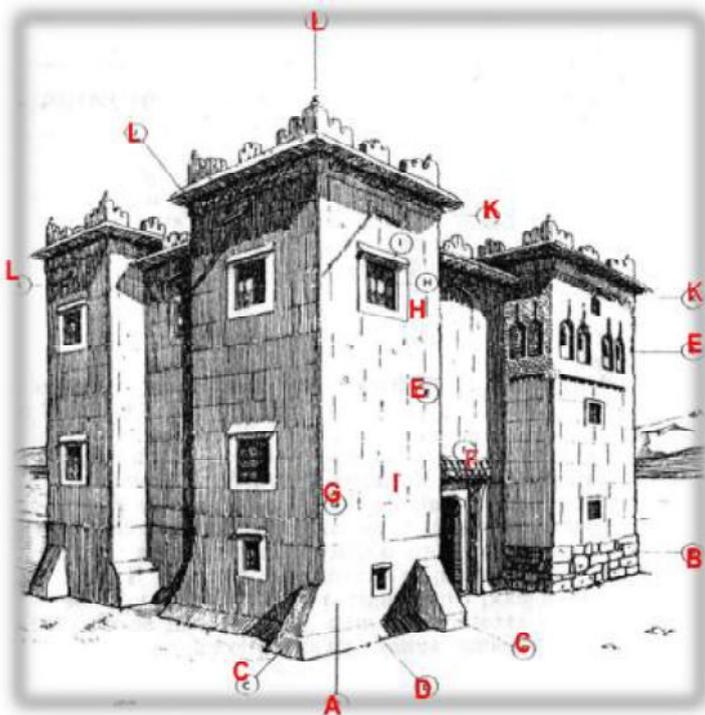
Le schéma de bonne conception architecturale d'un bâtiment en terre
